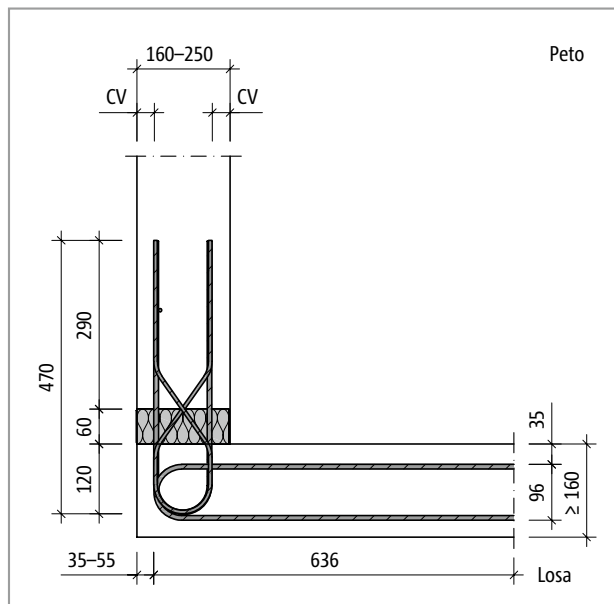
Schöck Isokorb® T tipo A-MM1-X60: Sección del producto
